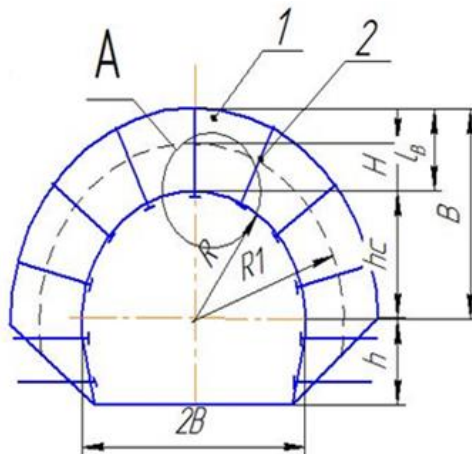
Схема формирования несущей конструкции в нарушенных породах 1 - зона разрушенных пород; 2- упрочненный штангами несущий породный свод
